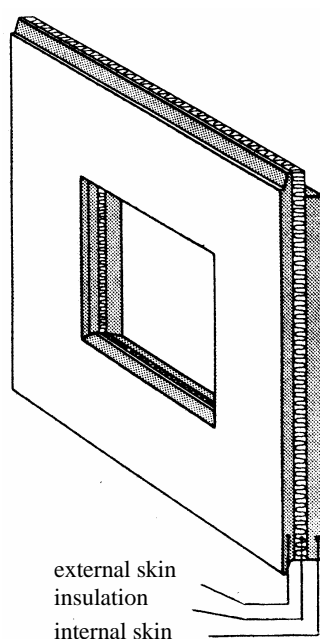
Princípio de painel sanduíche para fachada em concreto arquitetônico
